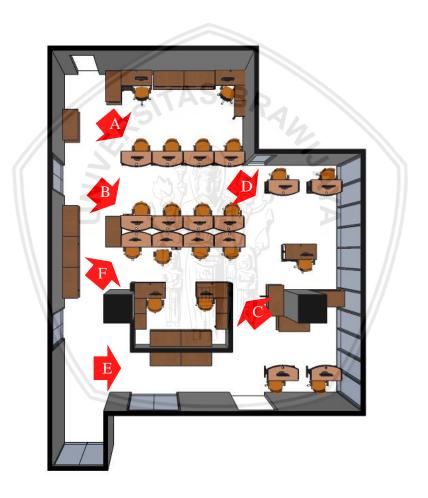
Layout ruang eksisting dengan alternatif desain.
